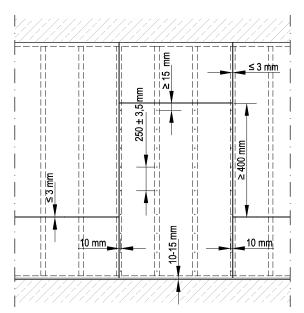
Montaje de las placas de la cara interior e intermedias.
